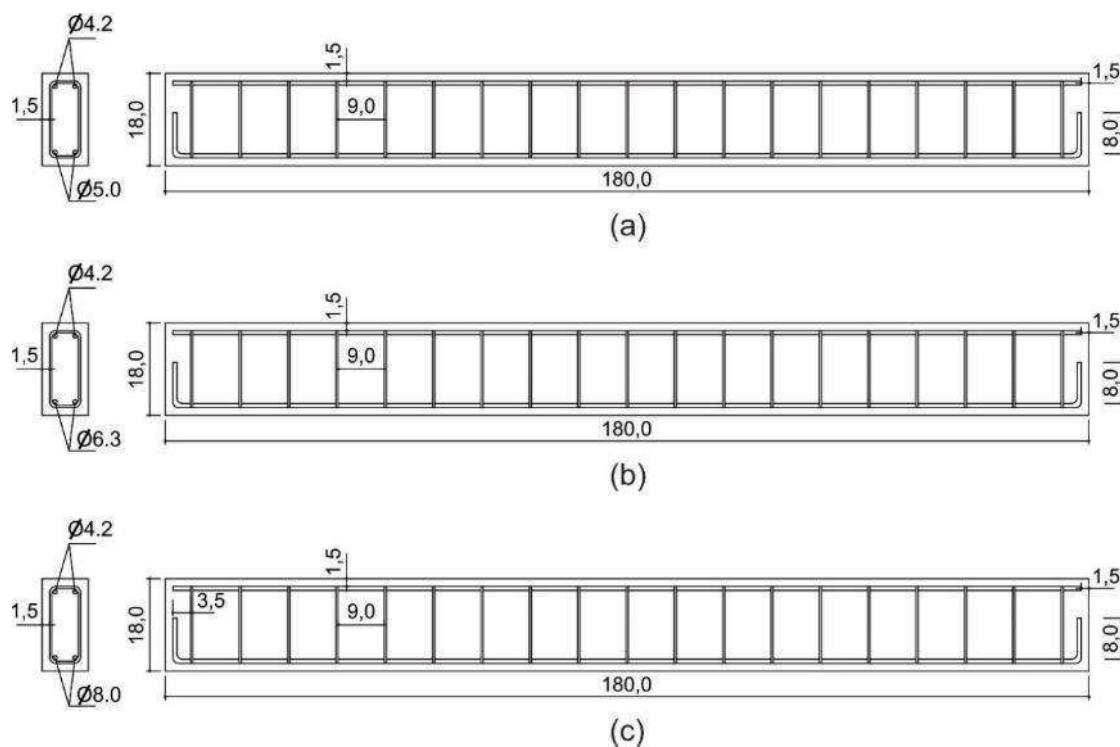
Detalhamento da armadura dos modelos experimentais:
